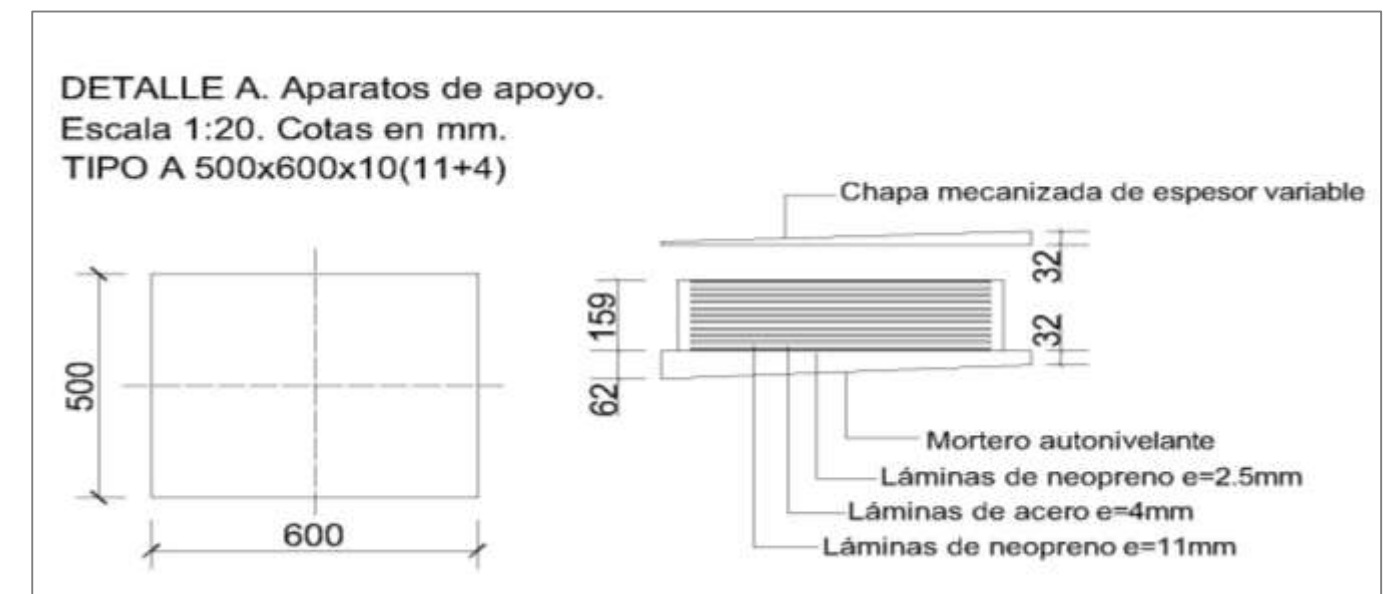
Detalle aparato de apoyo. Fuente: Elaboración propia.
